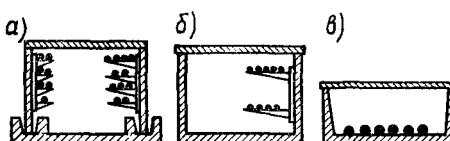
Сборные железобетонные каналы и расположение в них кабелей:
